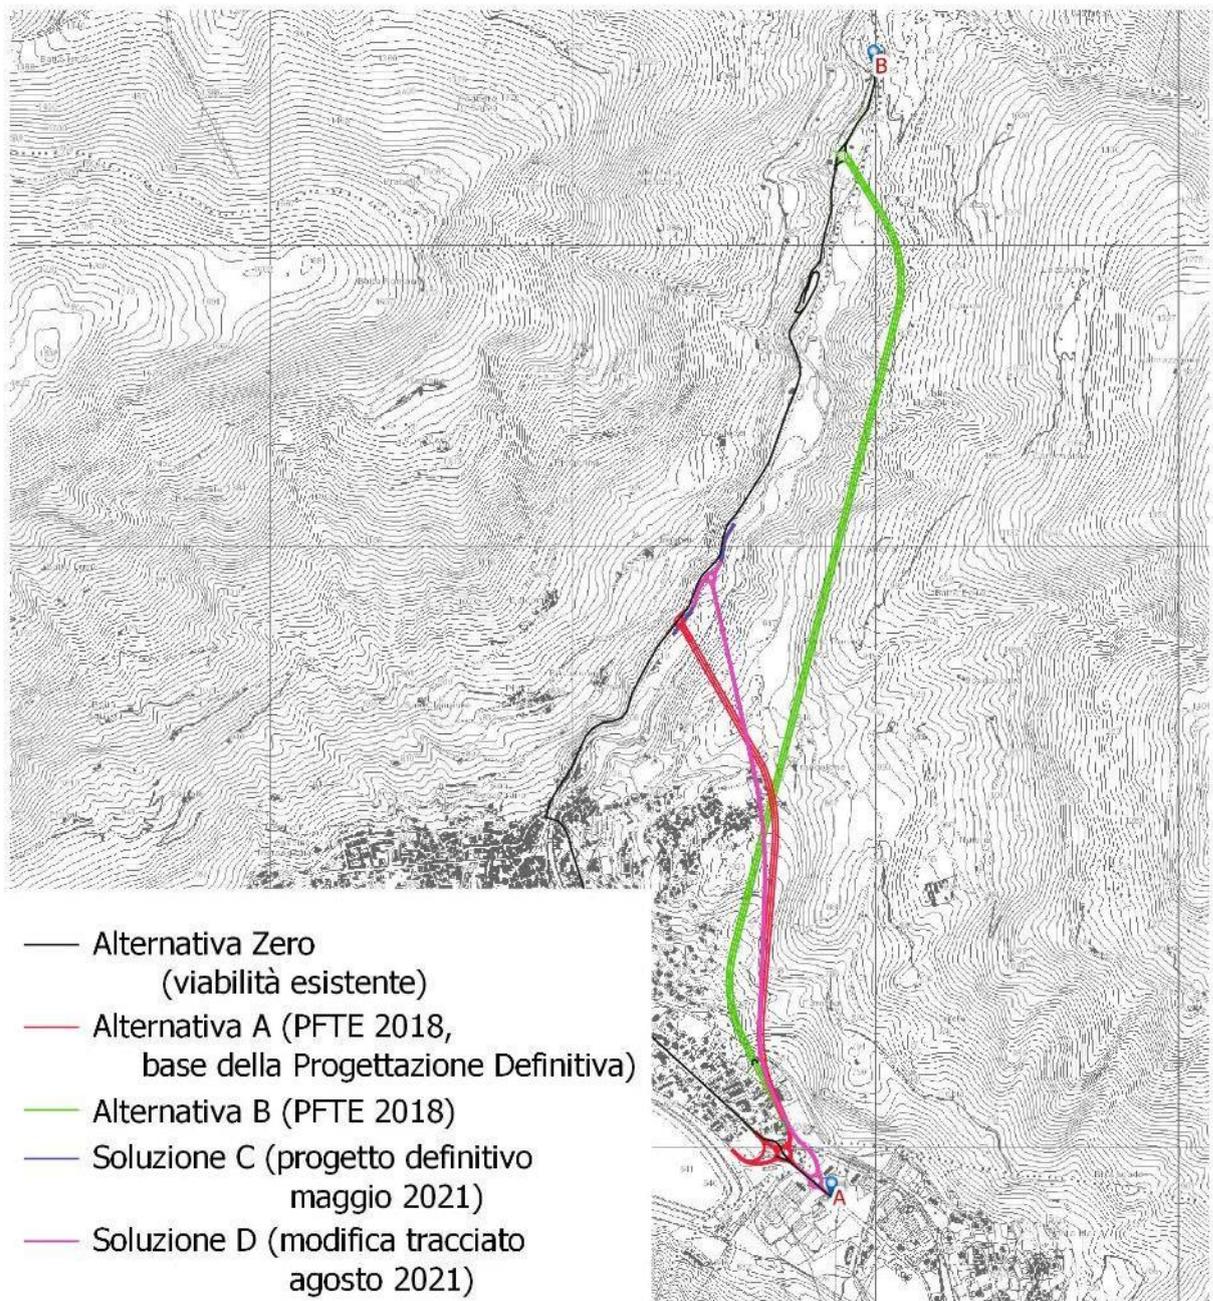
Planimetria delle quattro soluzioni alternative di progetto
